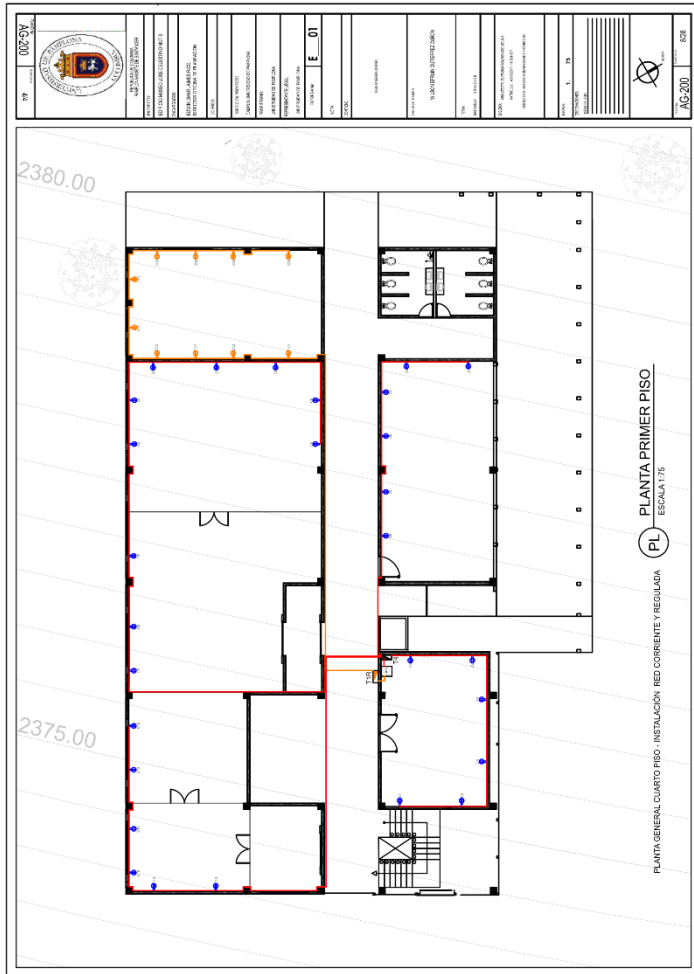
PLANTA PRIMER PISO INSTALACIONES ILUMINARIAS
